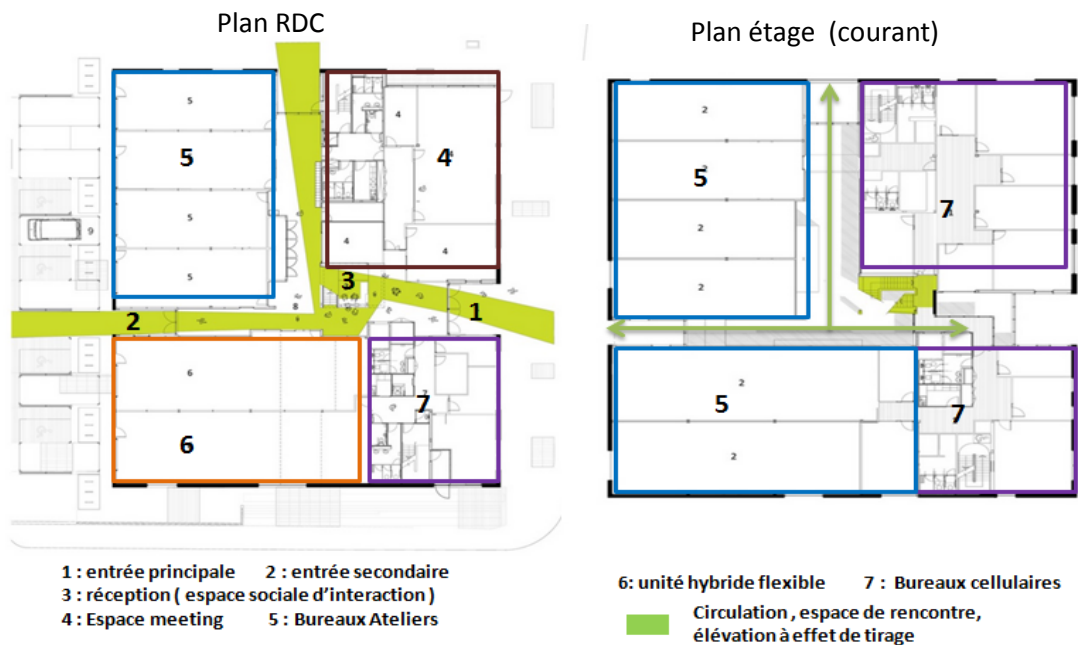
Analyse fonctionnelle plan RDC et plan étage. Source : Archdaily.com traité par auteur
